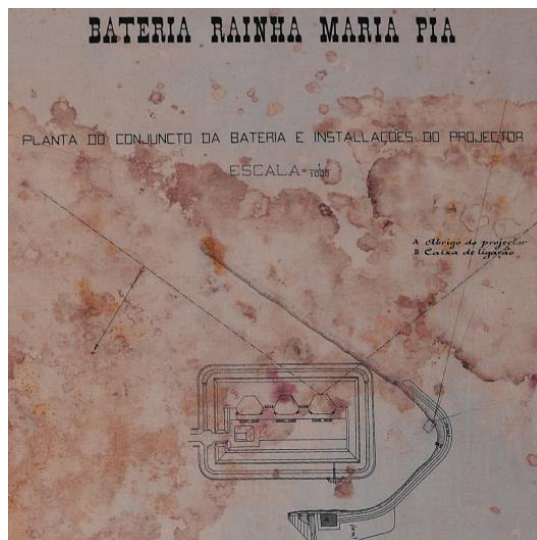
Planta do conjunto da Bateria e instalações do projetor
